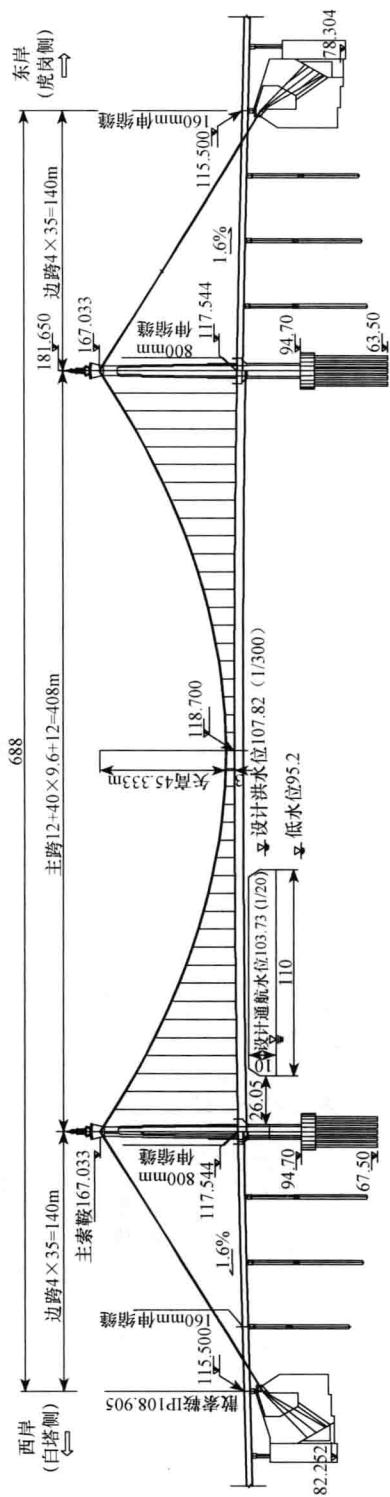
赣州大桥主桥布局图 (尺寸单位: m)
